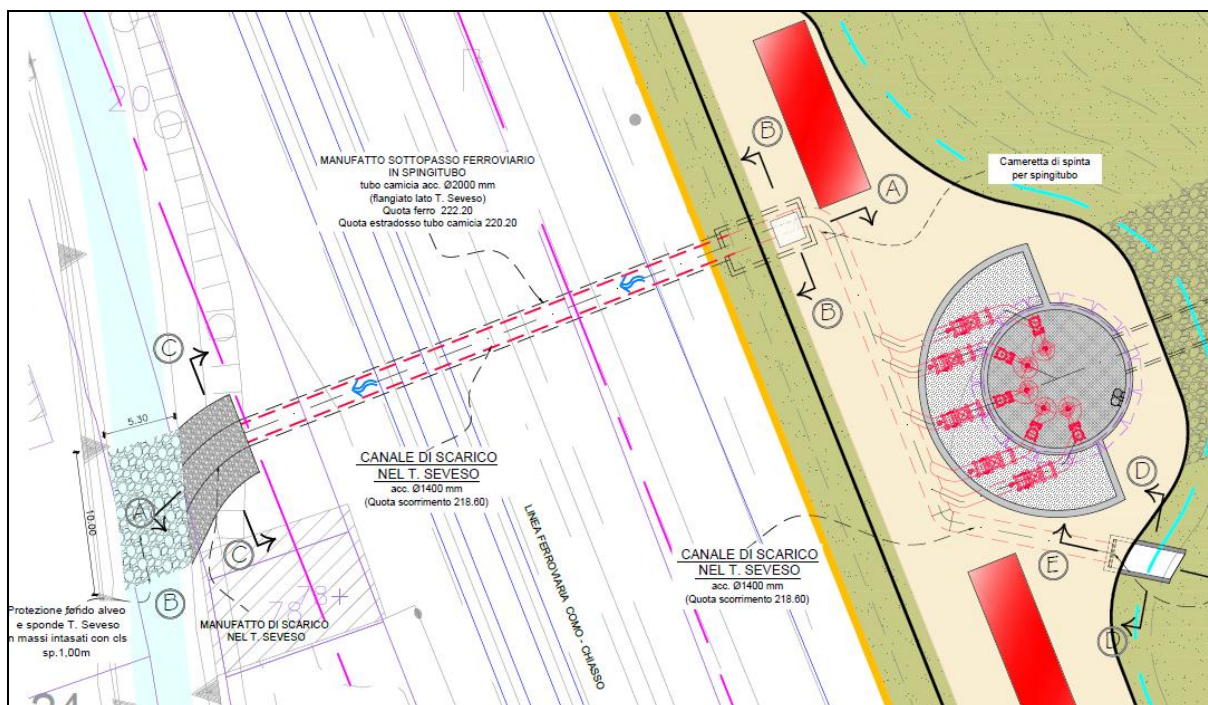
Stralcio della planimetria della vasca di laminazione di Lentate sul Seveso con indicazione del sollevamento meccanico e delle opere di scarico
